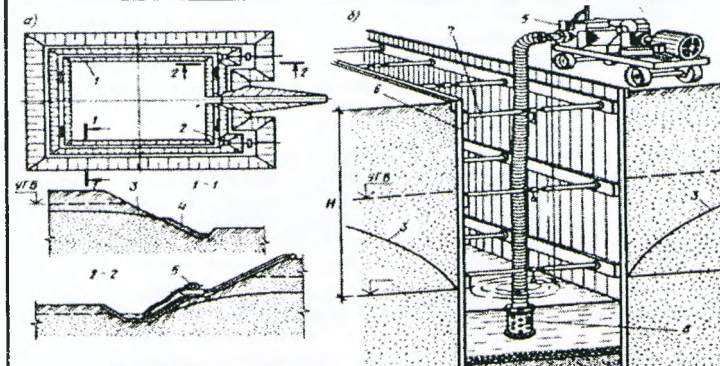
Открытый водоотлив из котлована (а) и траншеи (б):
